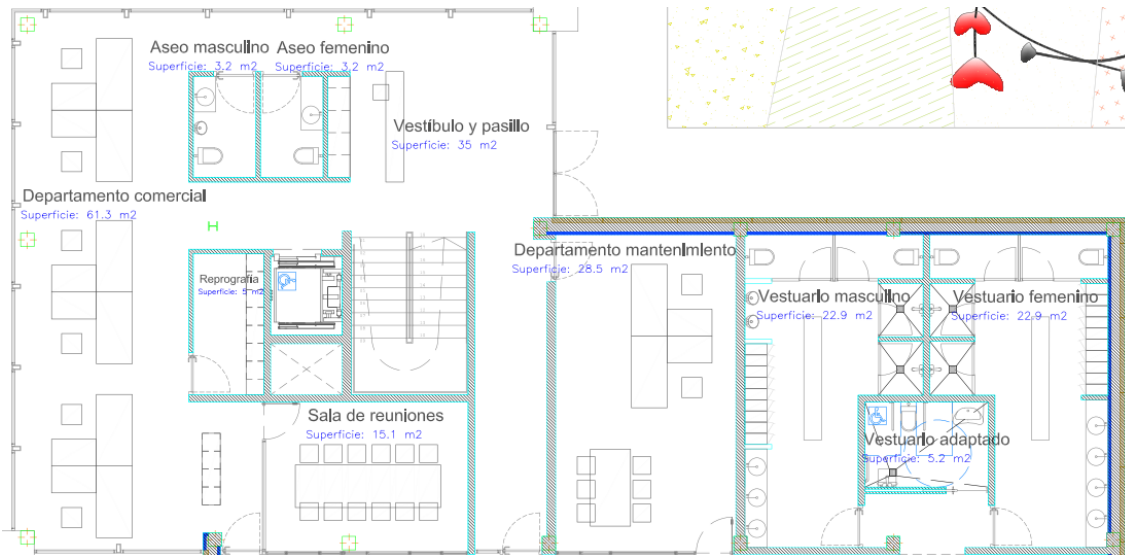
Distribución planta baja Nave de Fabricación y Oficinas [Elaboración propia]
